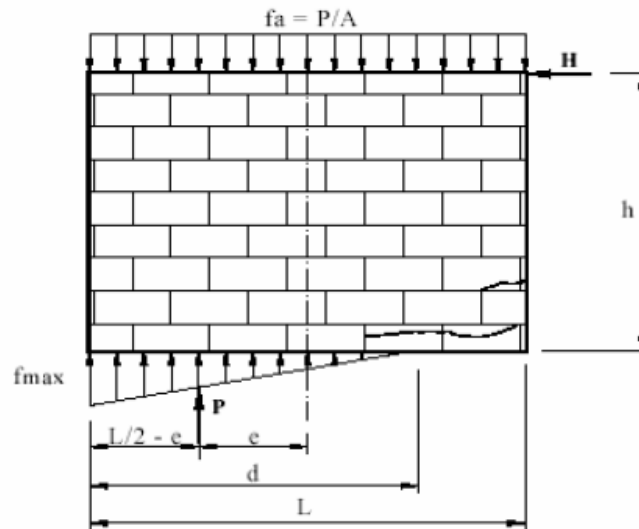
Panel de muro en mampostería. Fuente: (Gómez, Rodríguez, et al. 2006).
